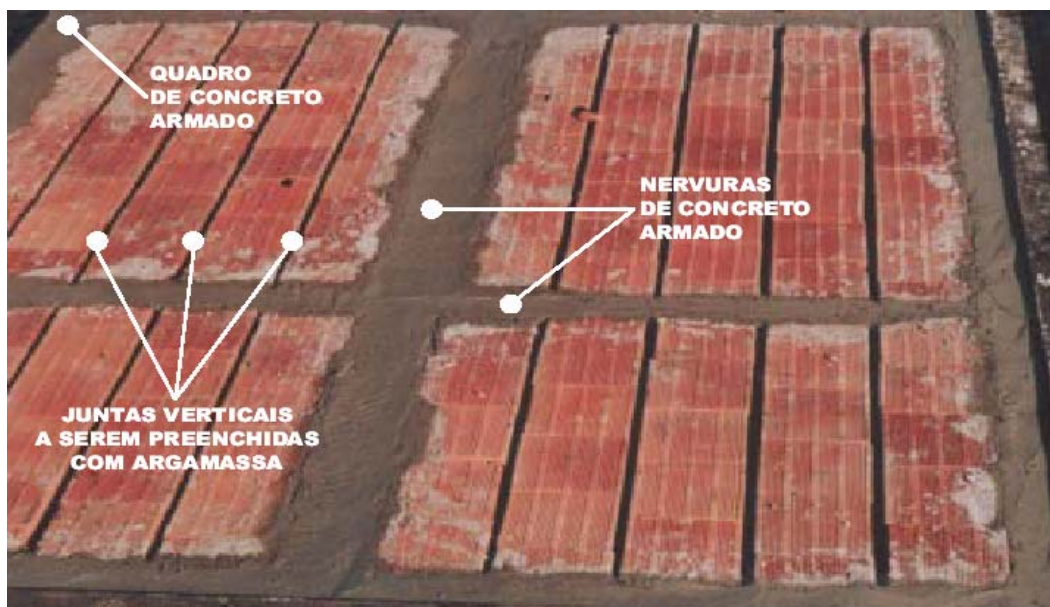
Painel com as nervuras, quadro de concreto armado e juntas verticais preenchidas com argamassa (IPT,2003).
